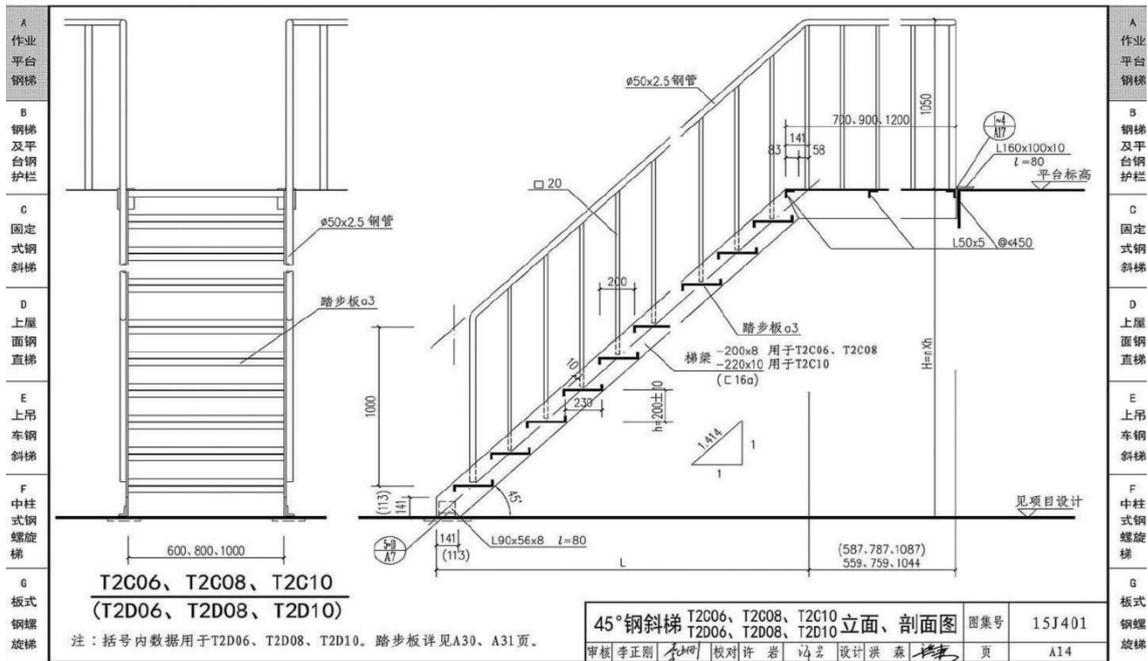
45° 钢斜梯做法立面、剖面图
